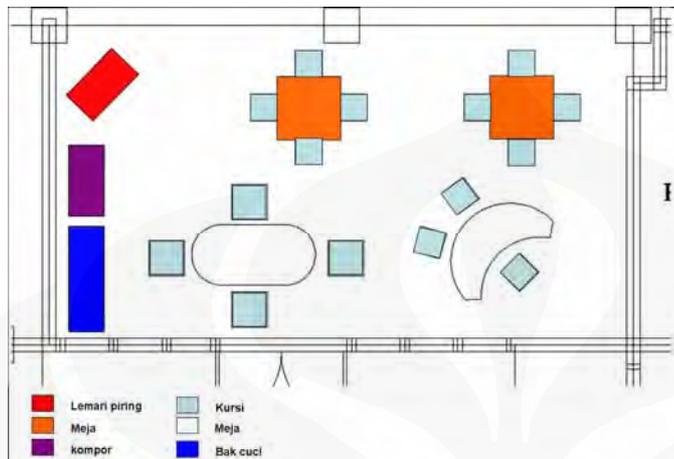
Pola Ruang Belajar Kasih Bunda ruang hijau
